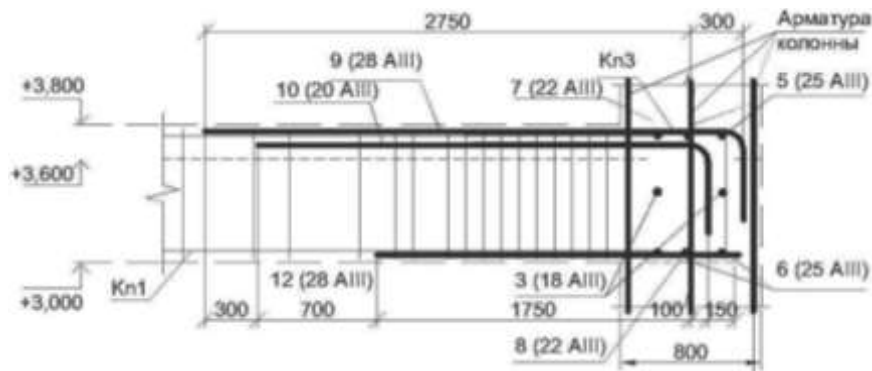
Армирование стыка колонны и ригеля при использовании гнутой арматуры
